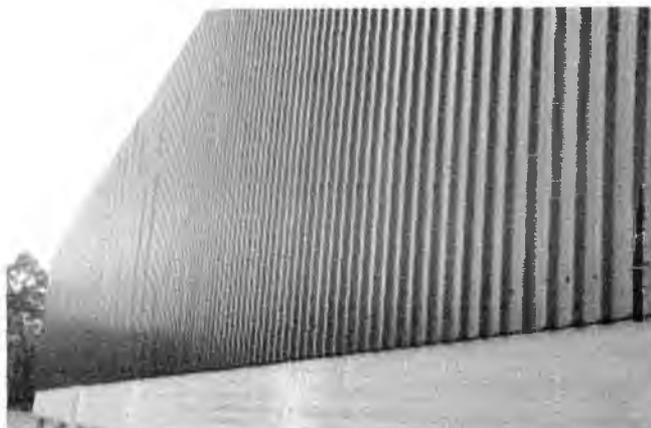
Telha metálica trapezoidal aplicada como revestimento de muro
